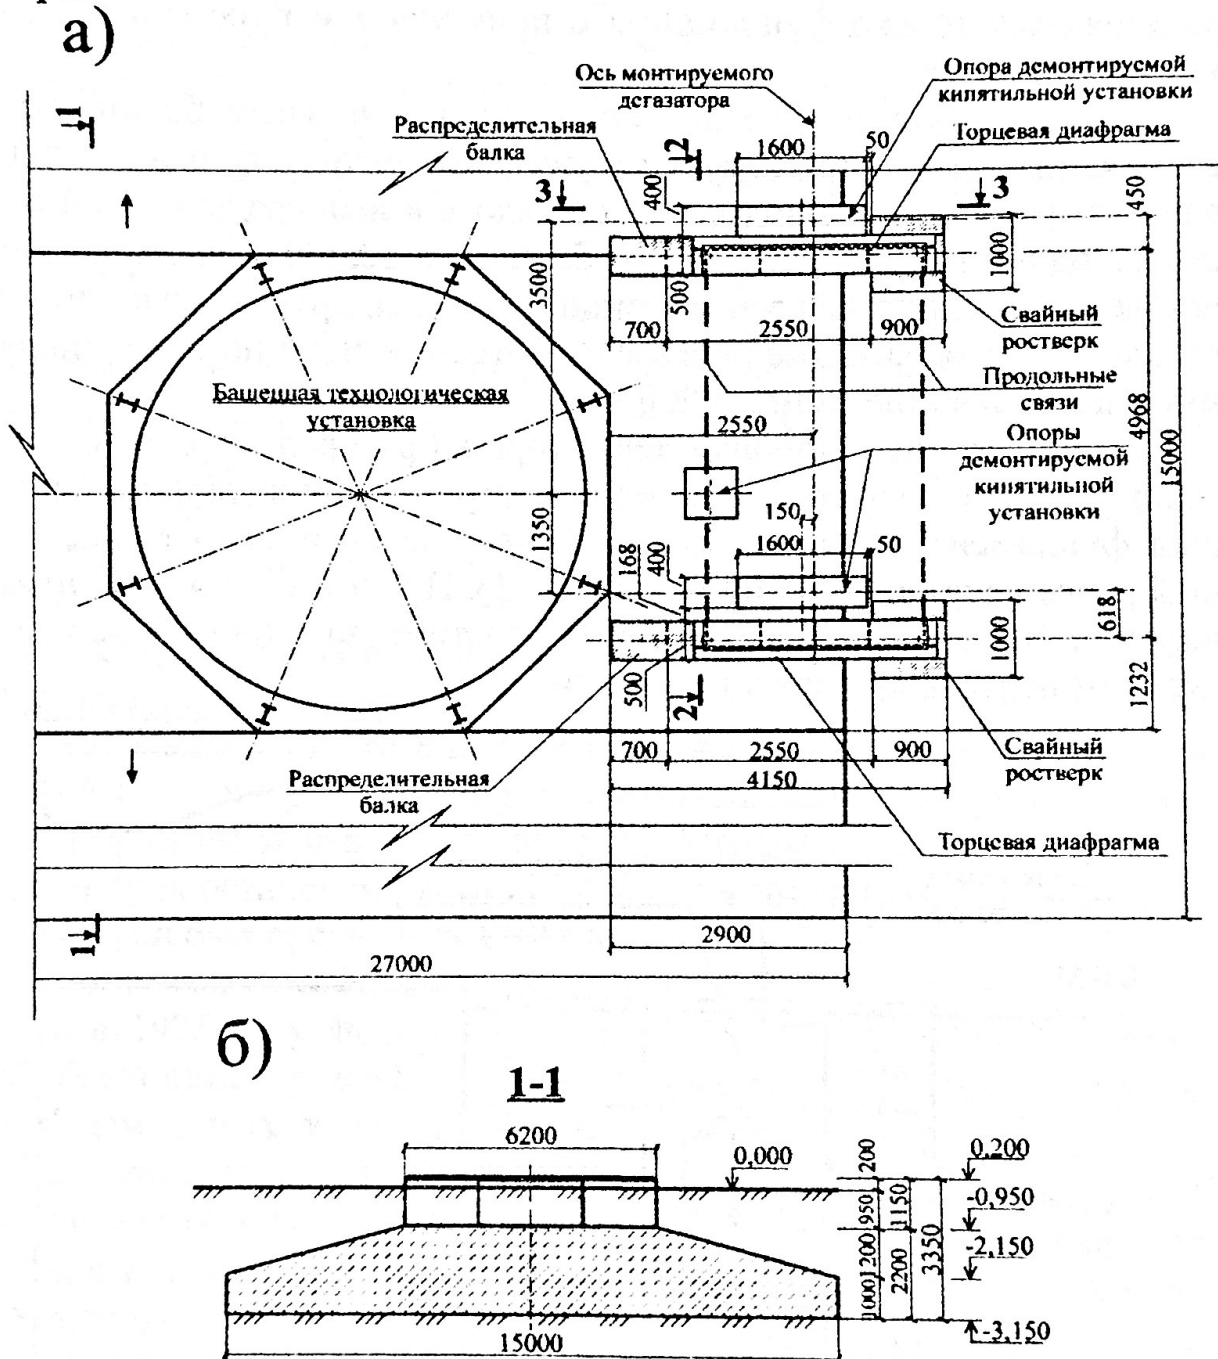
Схема опор монтируемого дегазатора; а — план, б — поперечное сечение фундаментной плиты
